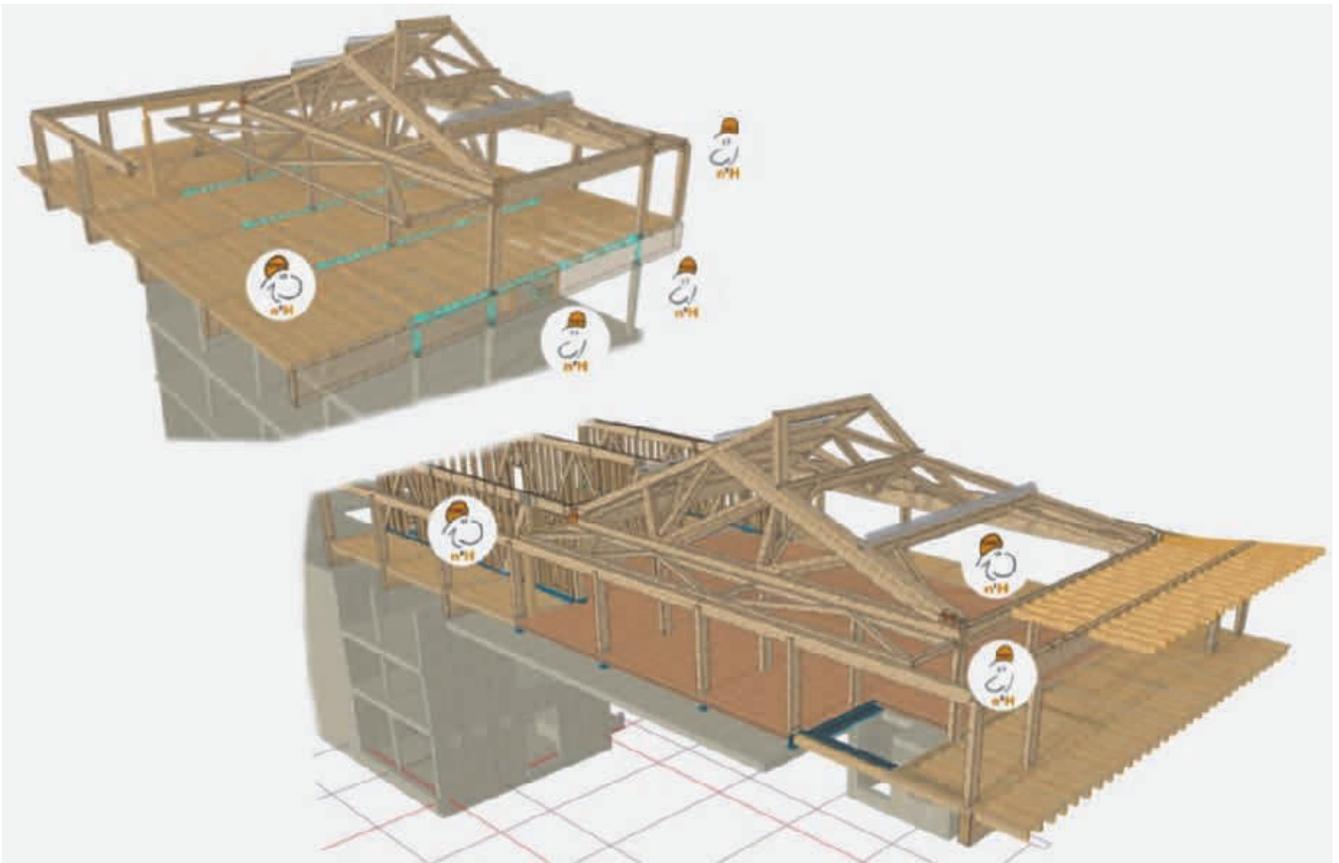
GSA®-Anschlusssteile in den Dachhauben
